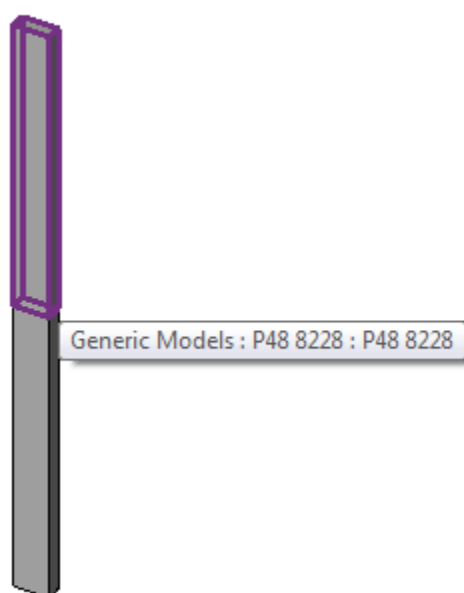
PILAR DIVIDIDO EM PAVIMENTOS (DEVERIA SER UM ELEMENTO ÚNICO)
